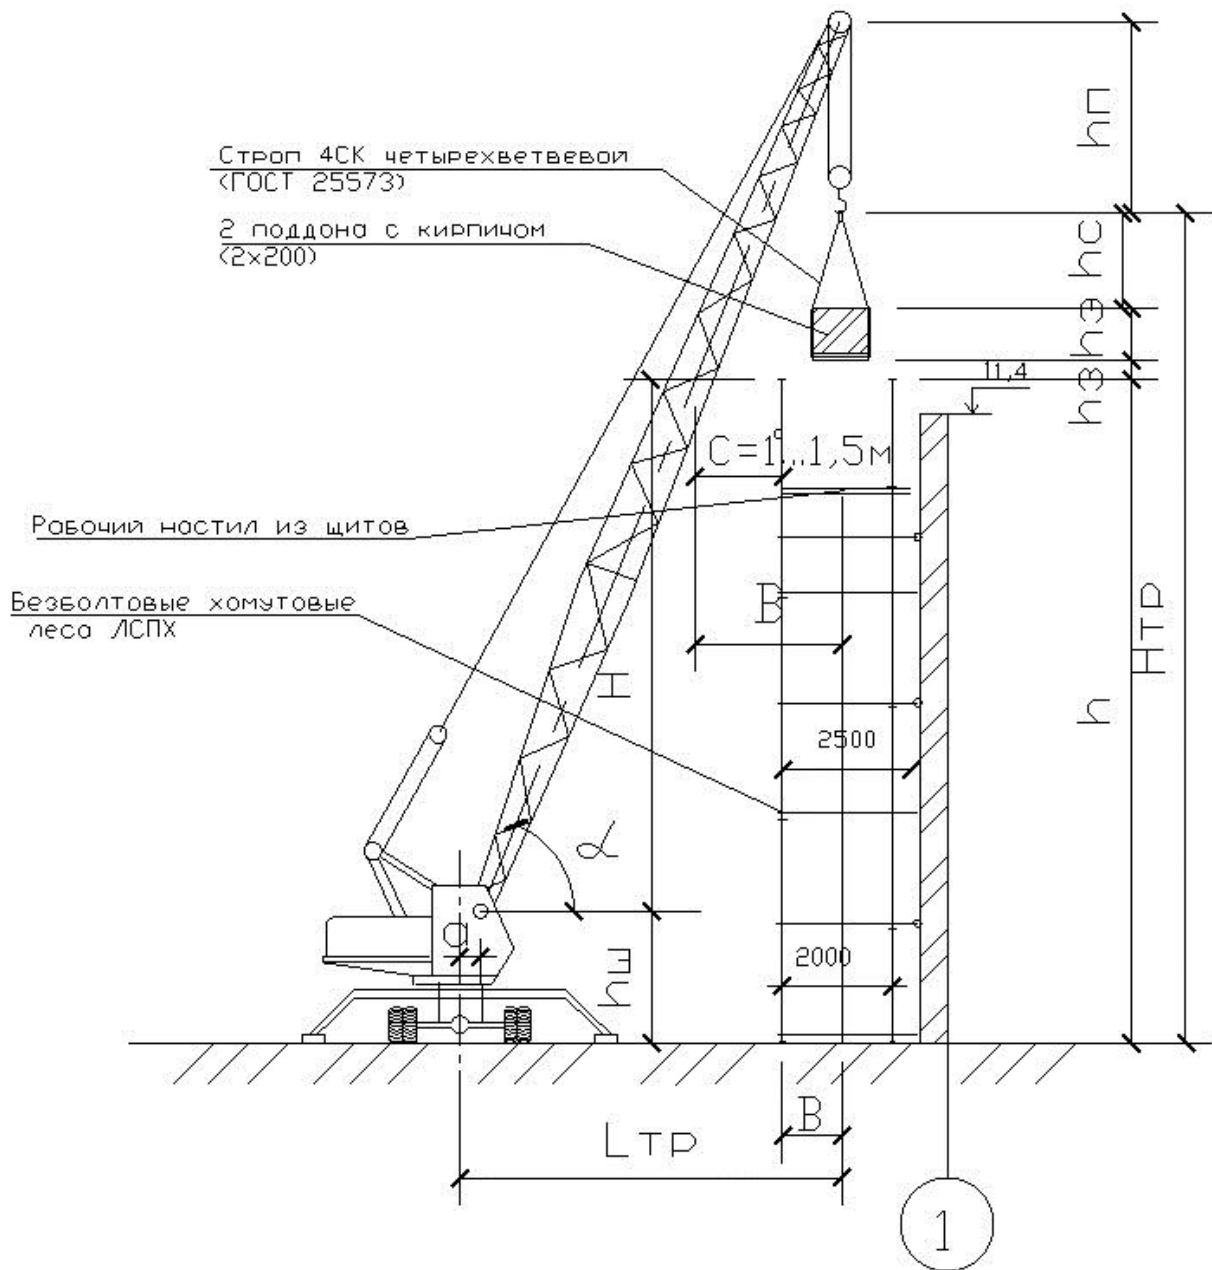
Расчетная схема к определению $L_{стр}$, $L_{тр}$ при подаче материалов для кладки стен
